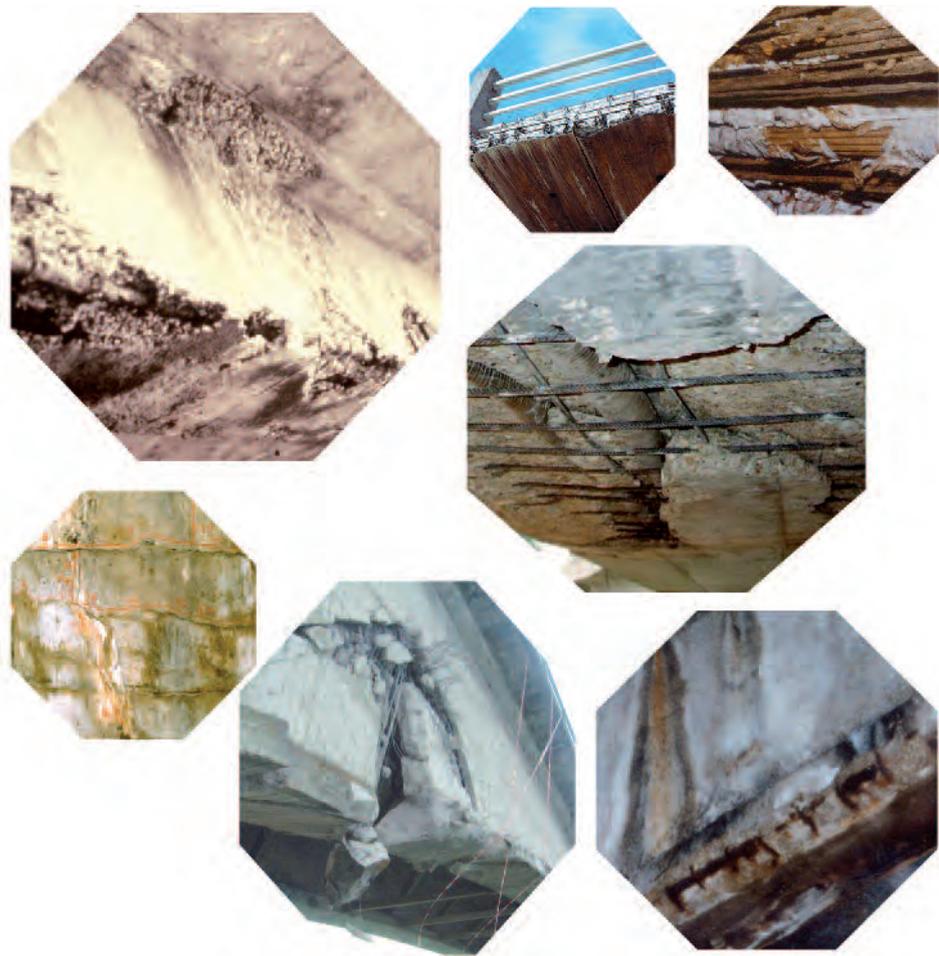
différents désordres de structures en béton armé et précontraint (photomontage)
